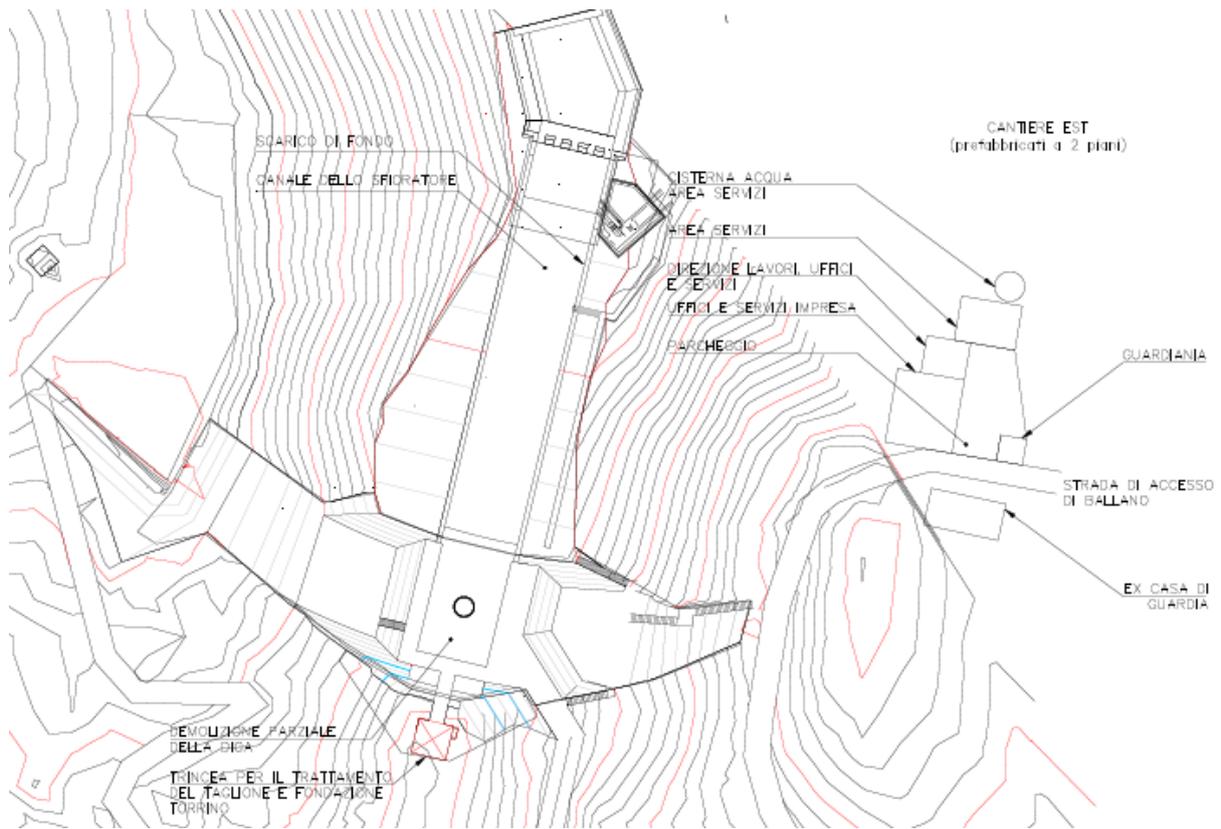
Particolare aree di lavoro sbarramento ed area di cantiere est
